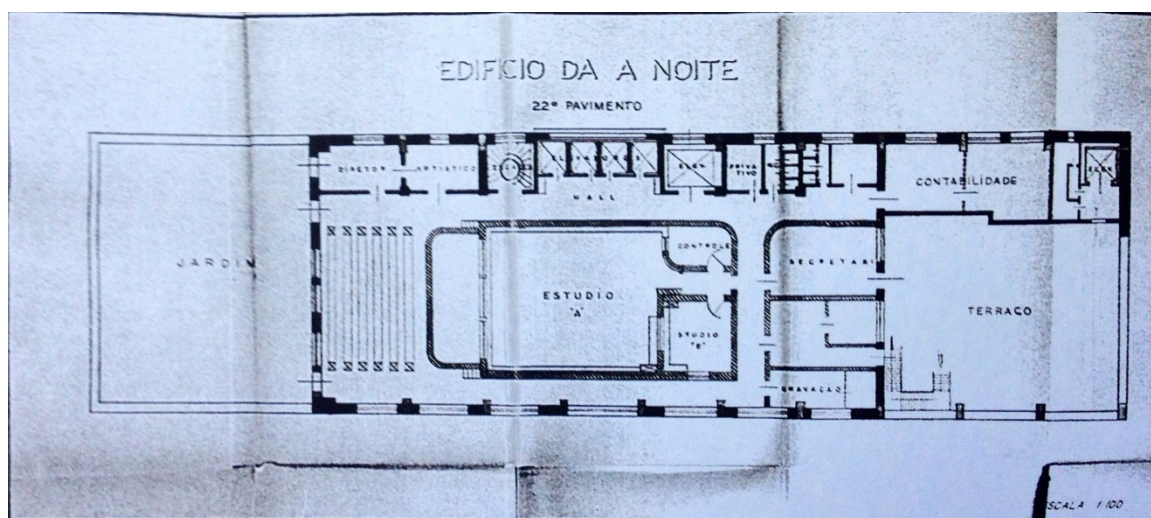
Planta do A Noite realizada nos anos 1940. 22 pavimentos. FONTE: CABOT, 2014.
